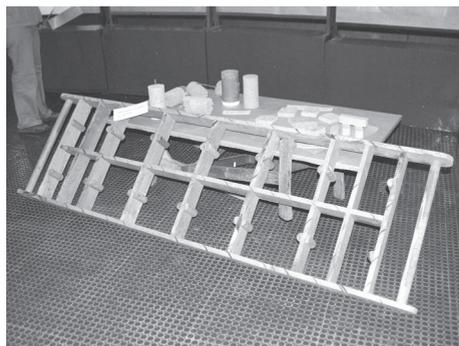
Moldes para fabricar adobes de distintas dimensiones simultaneamente.
